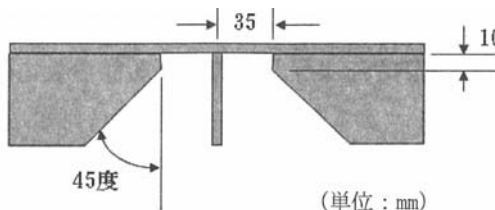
補剛材の切欠きの例（鋼道路橋防食便覧, 図-V.3.3, H26.3）
